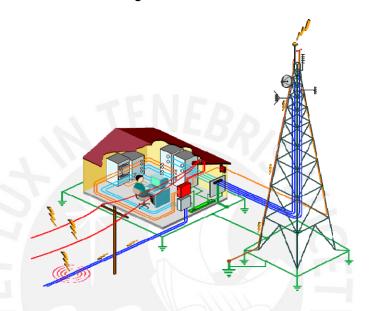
Diagrama Típico de elementos de protección contra descargas
